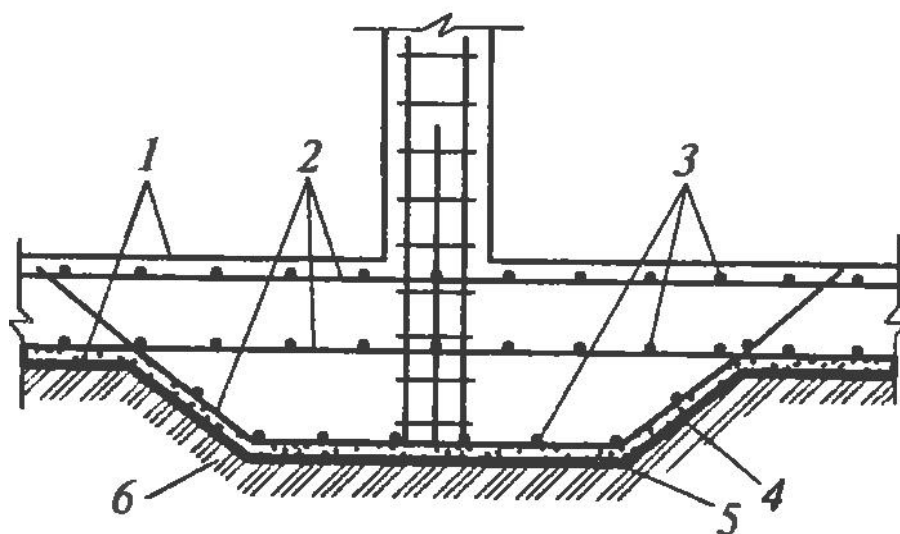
Схематическое сечение монолитной фундаментной плиты и выпусков под колонну 1) границы фундаментной плиты по высоте,
